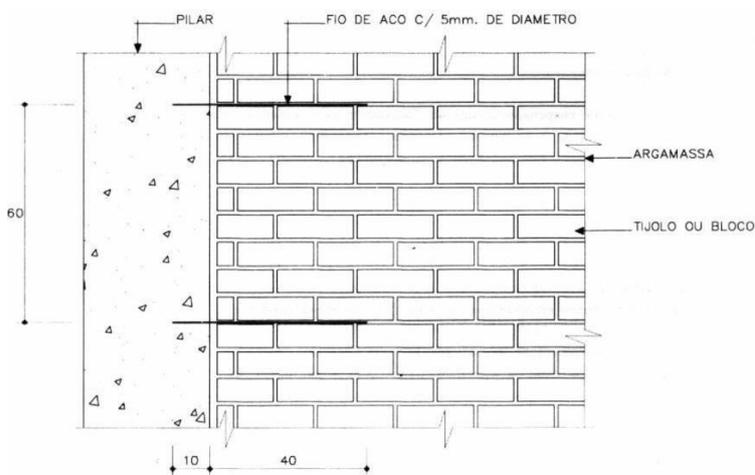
Detalhe ligação de alvenaria com pilares de concreto.
